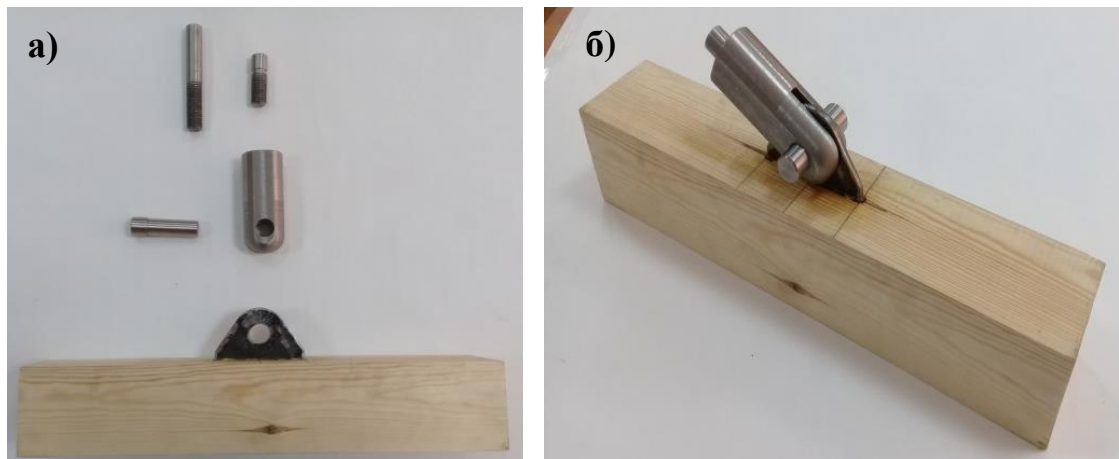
Универсальный образец с нагрузочным приспособлением:
